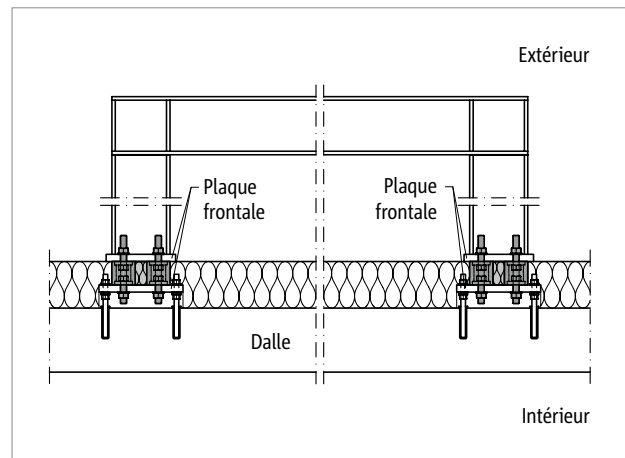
Schöck Isokorb® T type S-V : assemblage de cadre rigide pour structures secondaires (les moments supplémentaires dus aux imperfections doivent être pris en compte)
